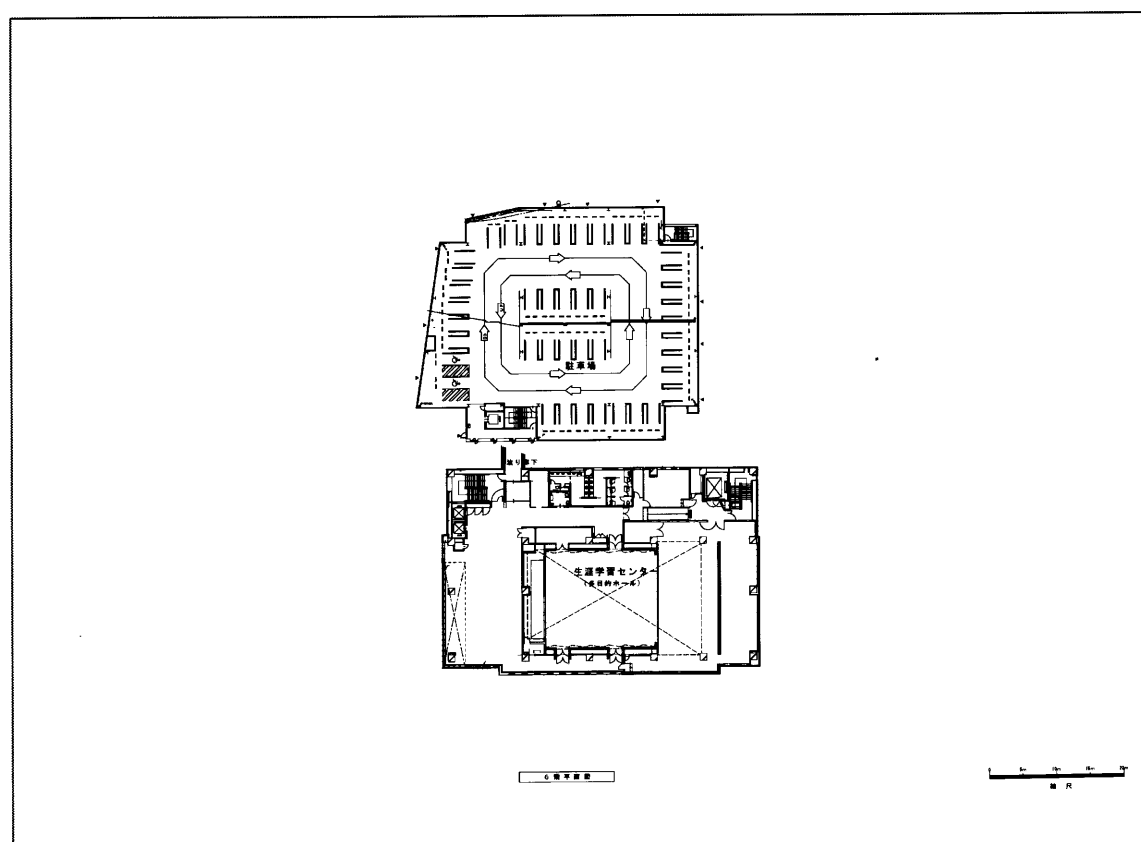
2 - 1 2 再開発ビルいなっせ 6 階平面図
